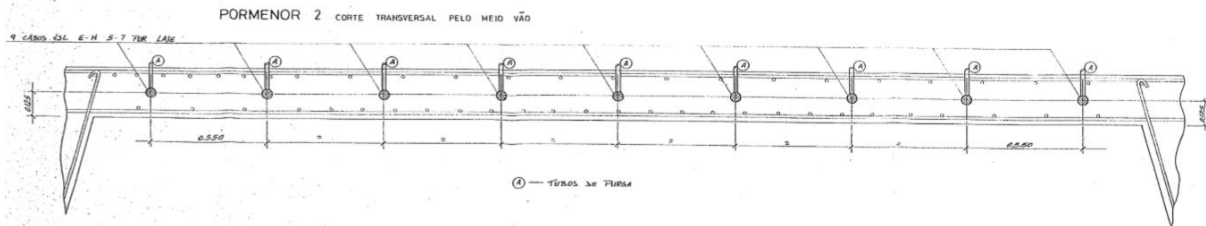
Desenho de projeto: pré-esforço longitudinal da laje entre nervuras (corte transversal)
